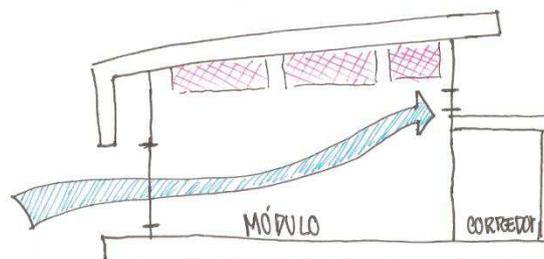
Croquis elemento esquadria e elemento vazado como parede dupla.
